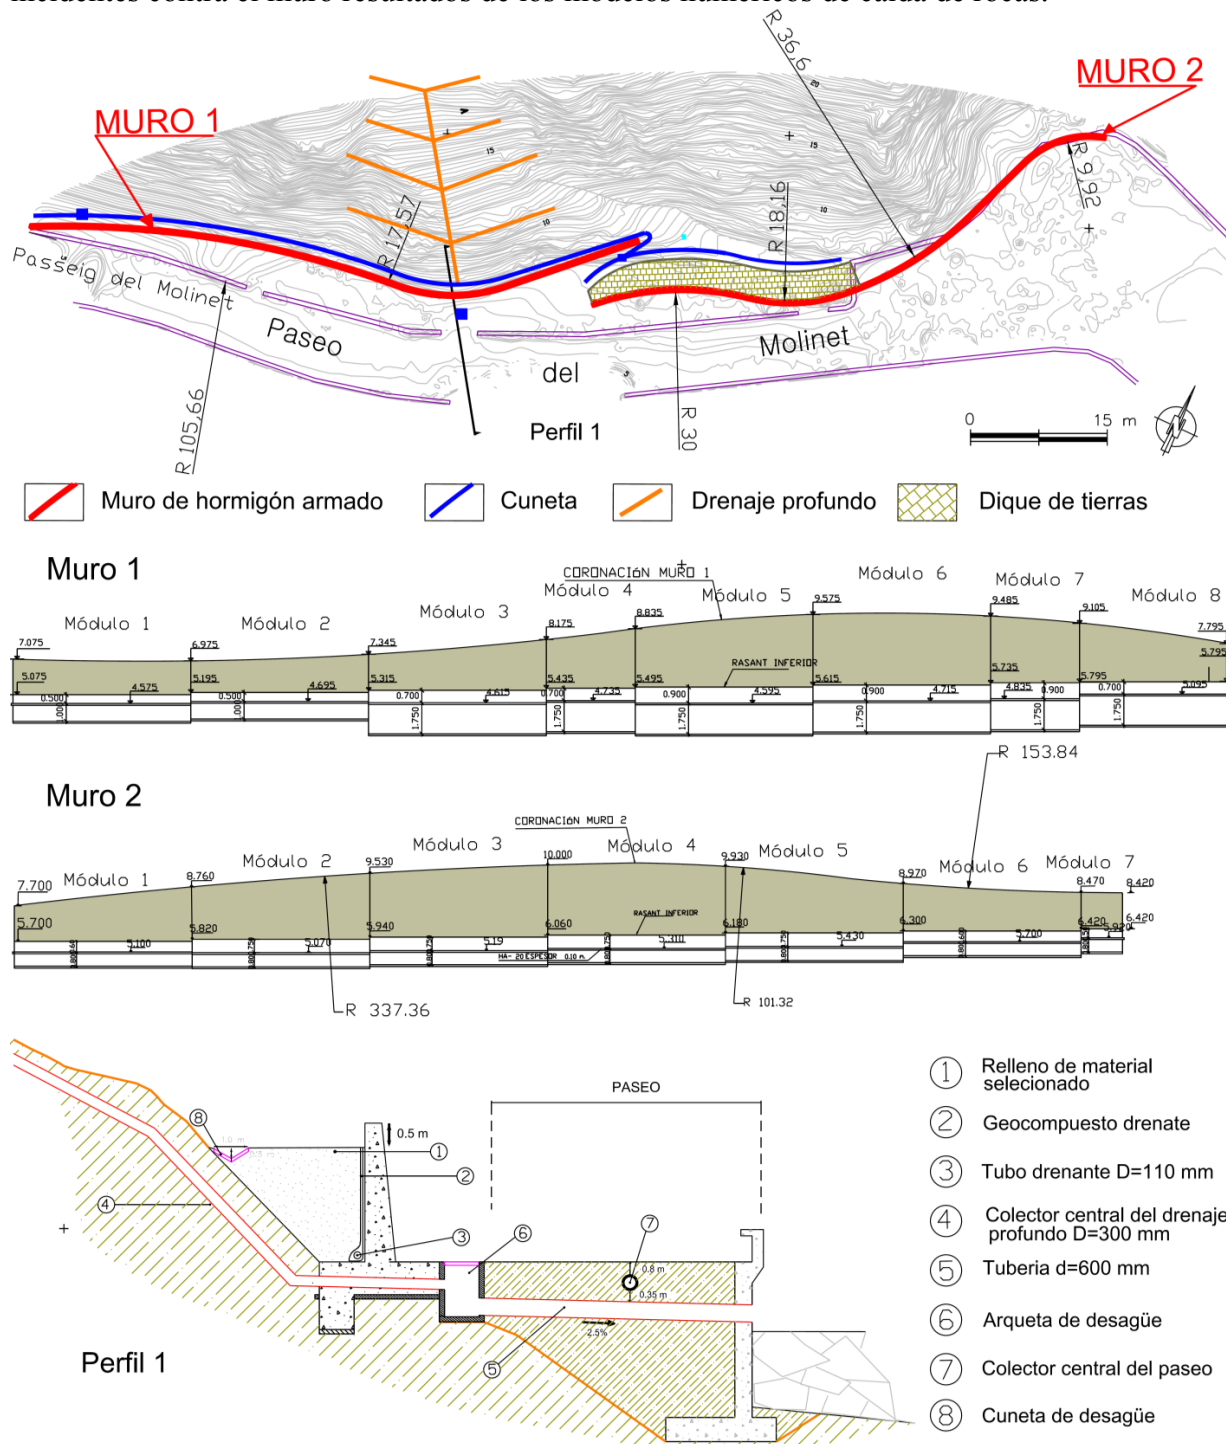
Esquema en planta de las actuaciones, alzado de los muros y una sección donde se detallan el sistema de evacuación de las aguas de escorrentía y profunda.
